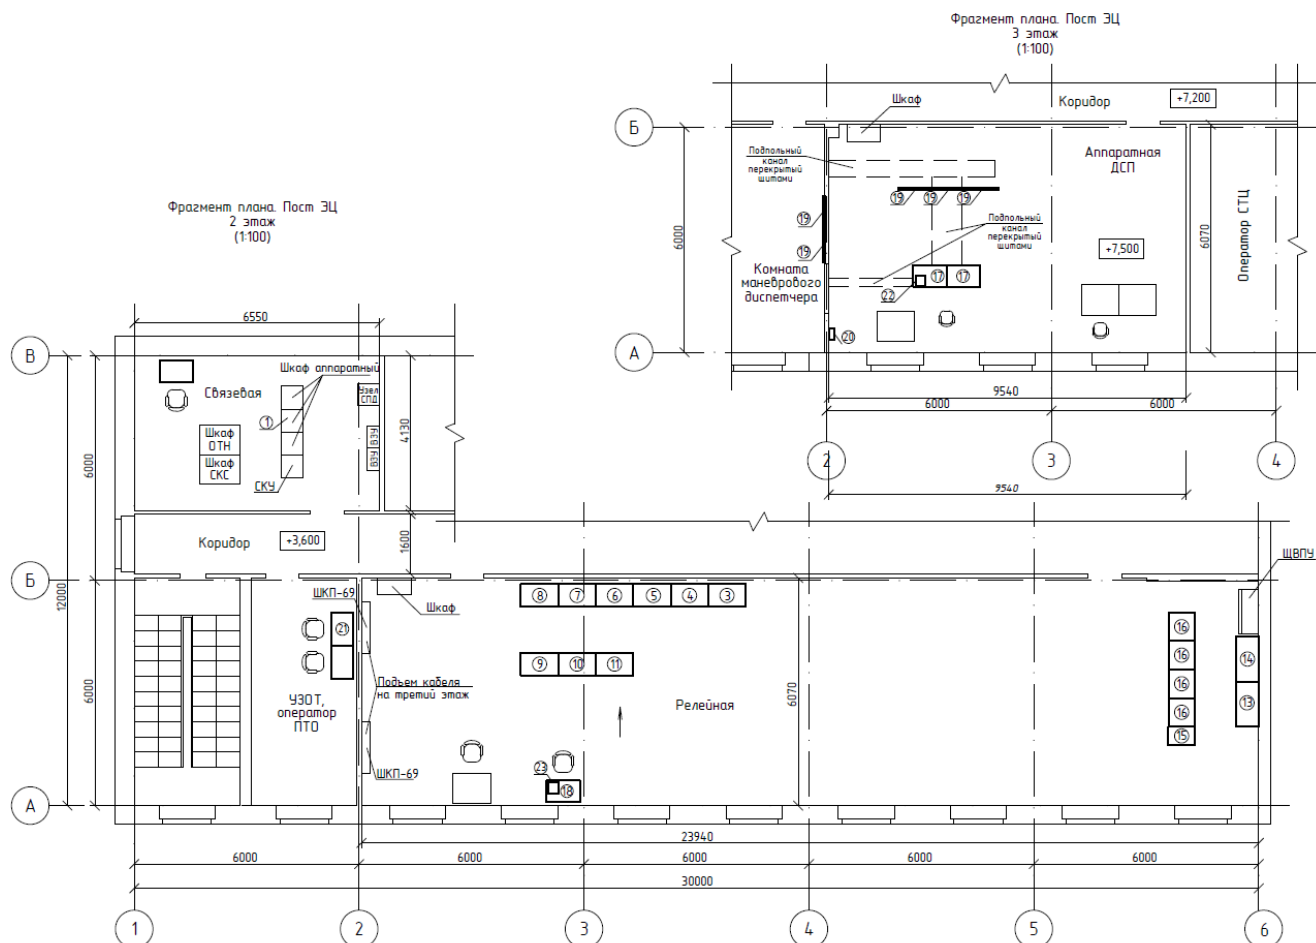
План расположения оборудования на 2 и 3 этаже
